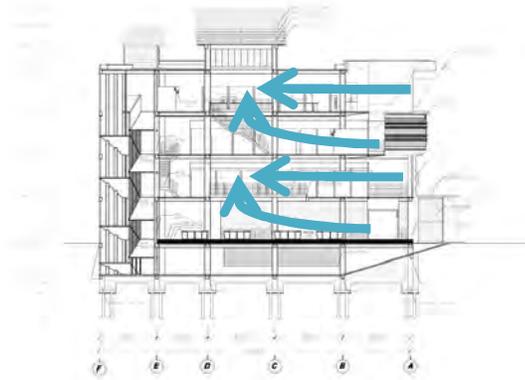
Pencahayaan Alami pada Lantai 1 dan Lantai 2
